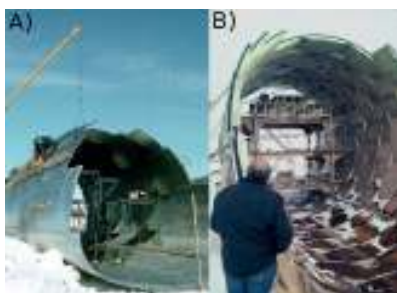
Konstrukcja kopuły w czasie budowy (southpolestation.com)
